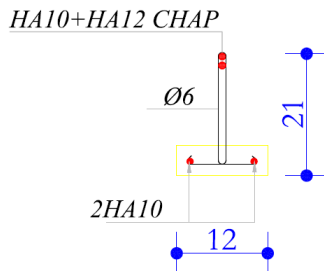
DETAIL FERRAILLAGE POUTRELLE EN APPUI DE RIVE
